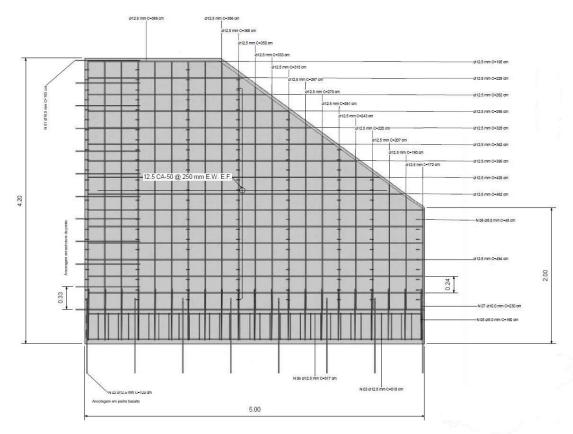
detalhamento das armaduras da contenção de concreto a ser executada para conter a erosão do talude nas cabeceiras da ponte; Fonte: o autor.
